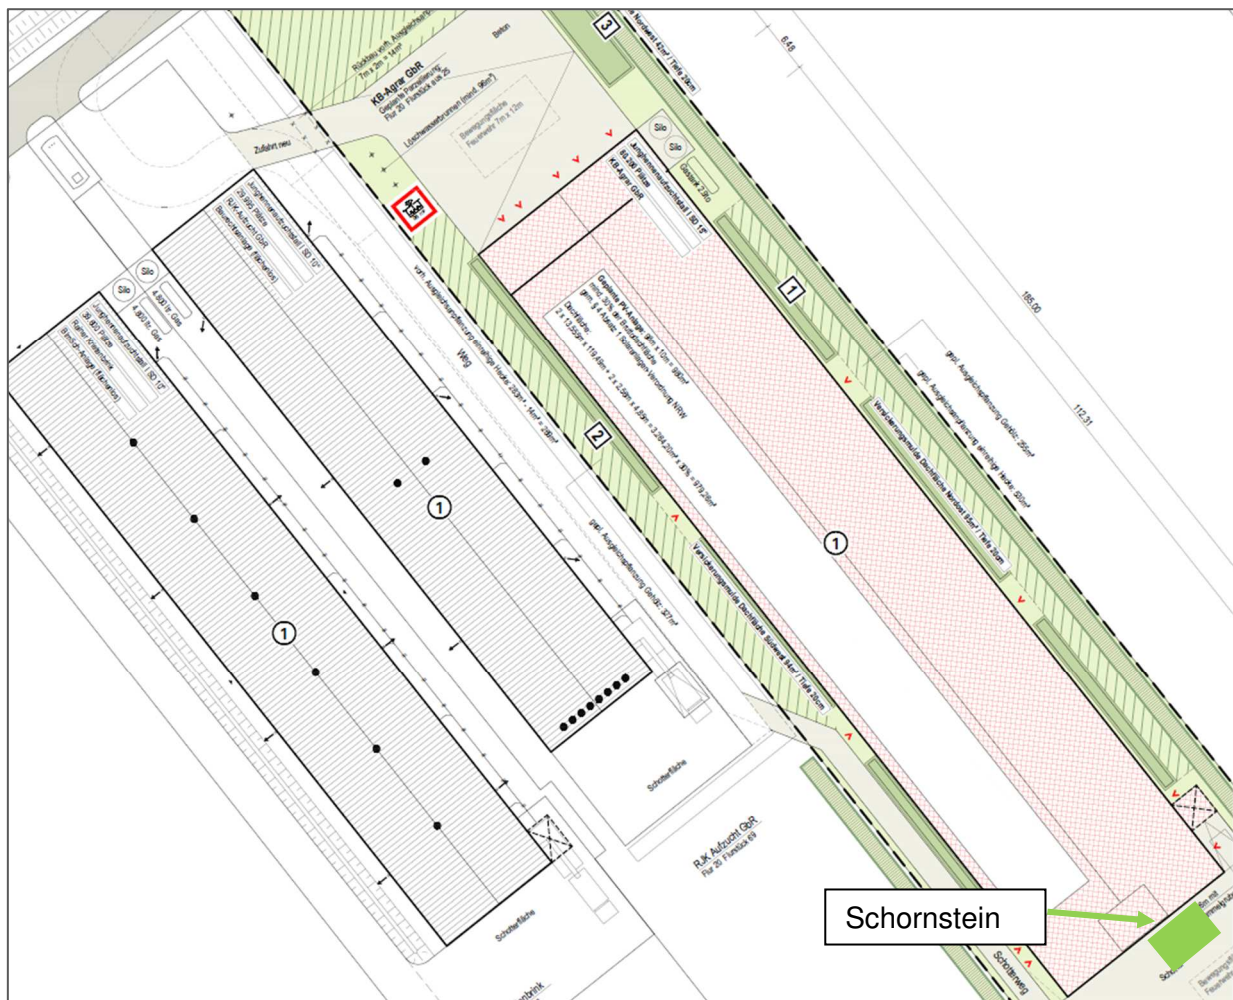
Lageplan mit geplanter Stallanlage auf dem Betriebsgelände der KB-Agrar GbR mit Schornsteinstandort [10]
